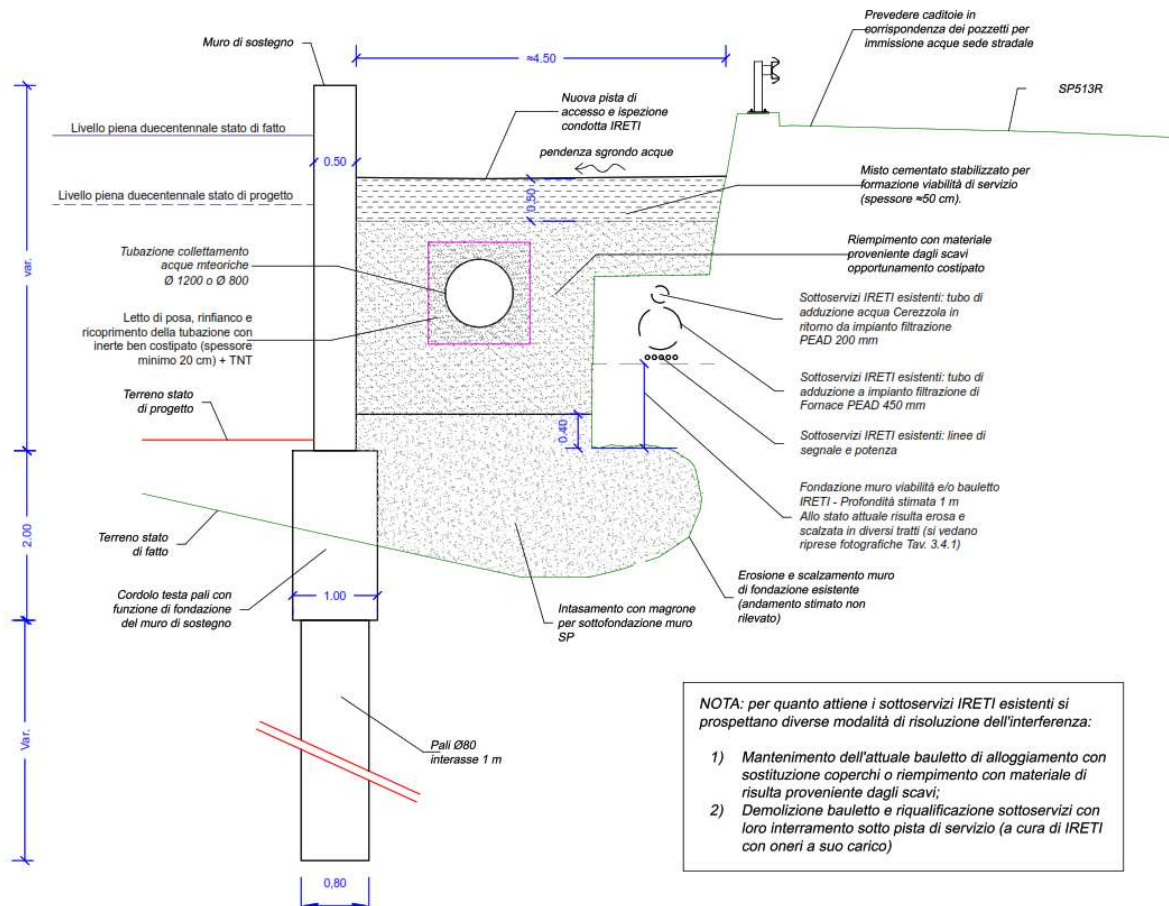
sezione tipologica di progetto estratta da tavola 3.4.3
